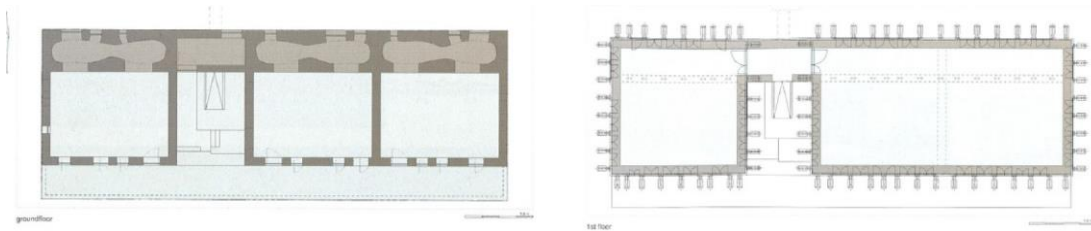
Grundrisse der Schule in Bangladesch (Quelle: Minke, 2009, S. 194)
